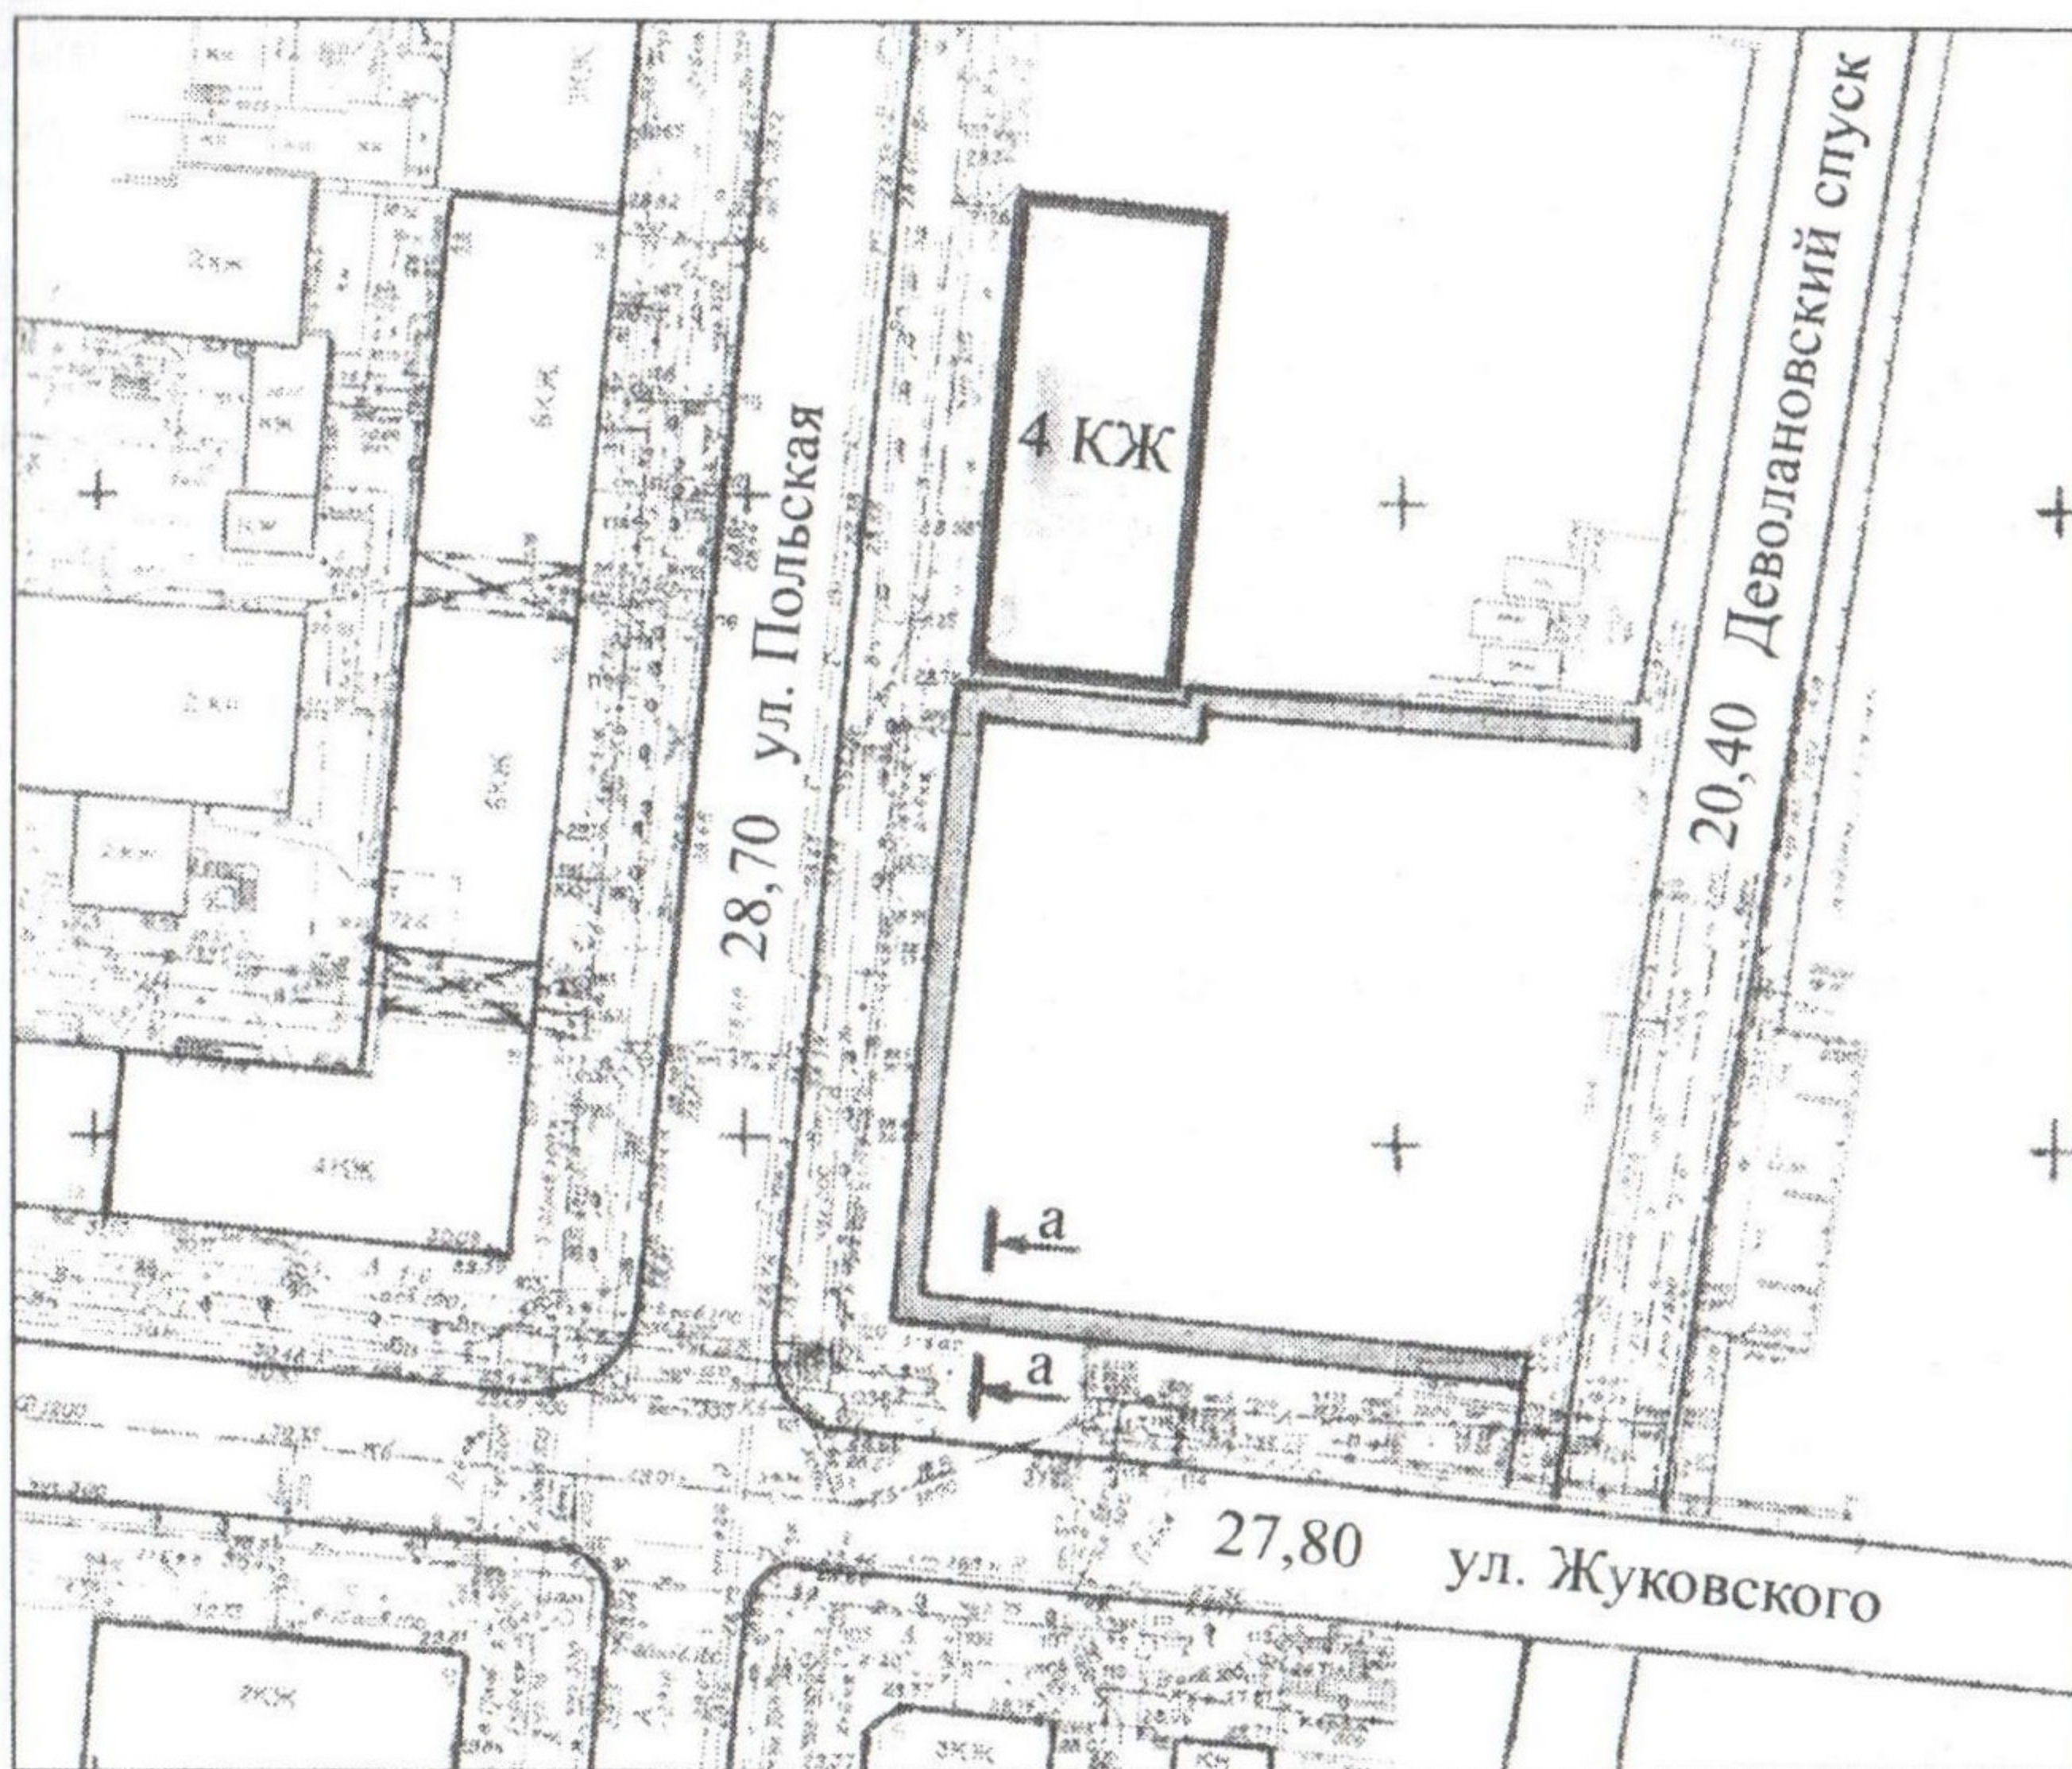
Ситуационный план расположения площадки по ул. Жуковского, 10 в г. Одессе с контурами ростверка свайного ограждения котлована строящегося здания.
